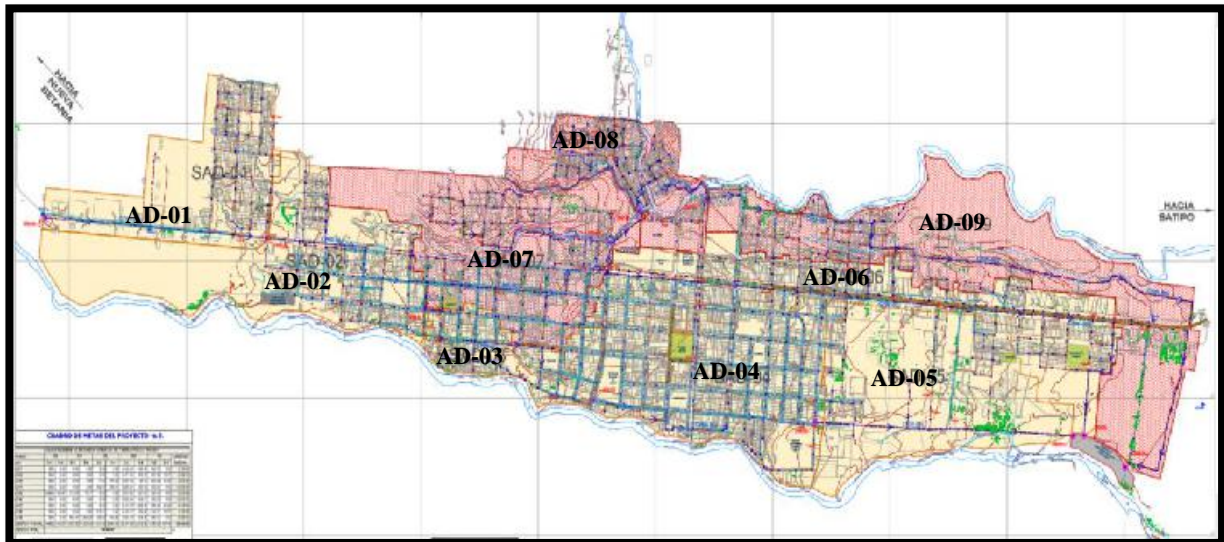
Plano de sectorización de áreas de drenaje en las redes de alcantarillado.
